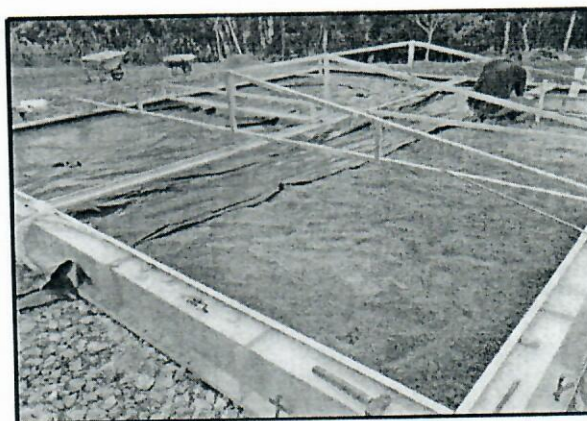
Aterro no interior da forma e colocação da lona plástica.
